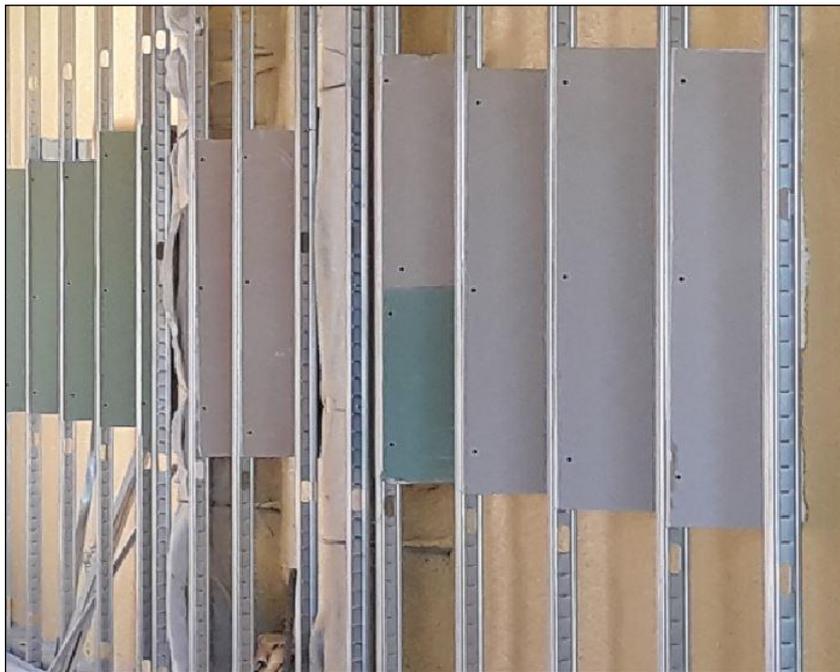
Vista general de un trasdosado autoportante con la subestructura rigidizada mediante lambetas en cada montante.
